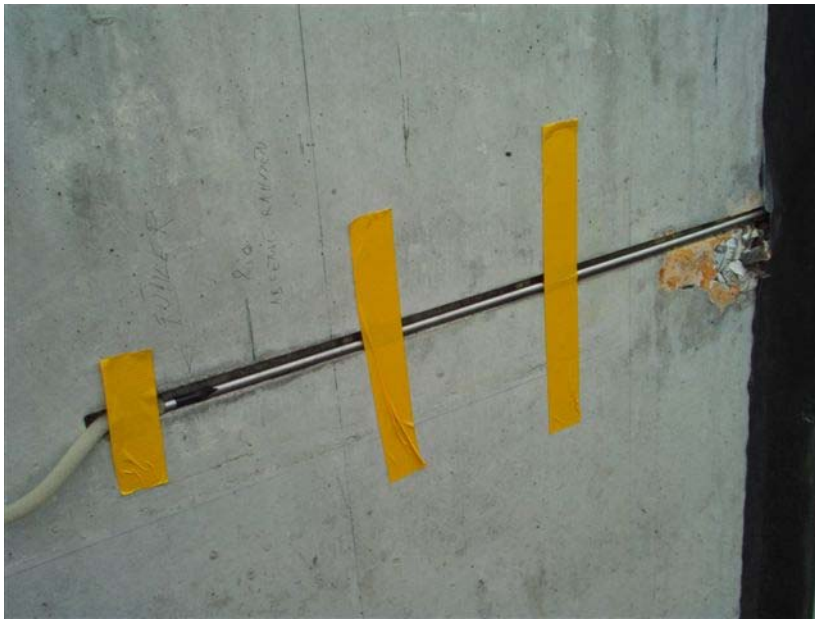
Einbau der Messfühler an Betonaussenwand.
